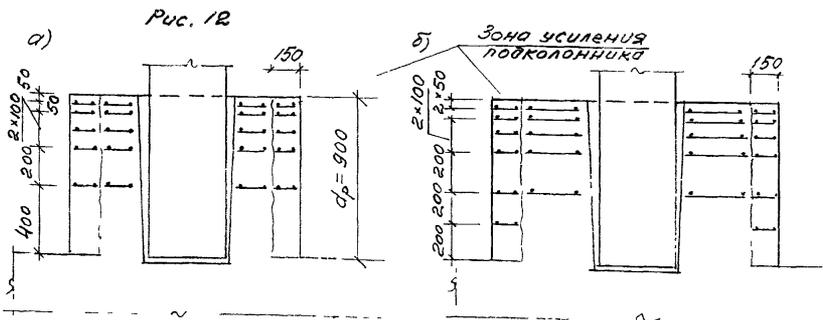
а) поперечное армирование стенок стакана усиленного подколонника фундамента под усиленную рядовую колонну; б) то же, - под связевую колонну.
